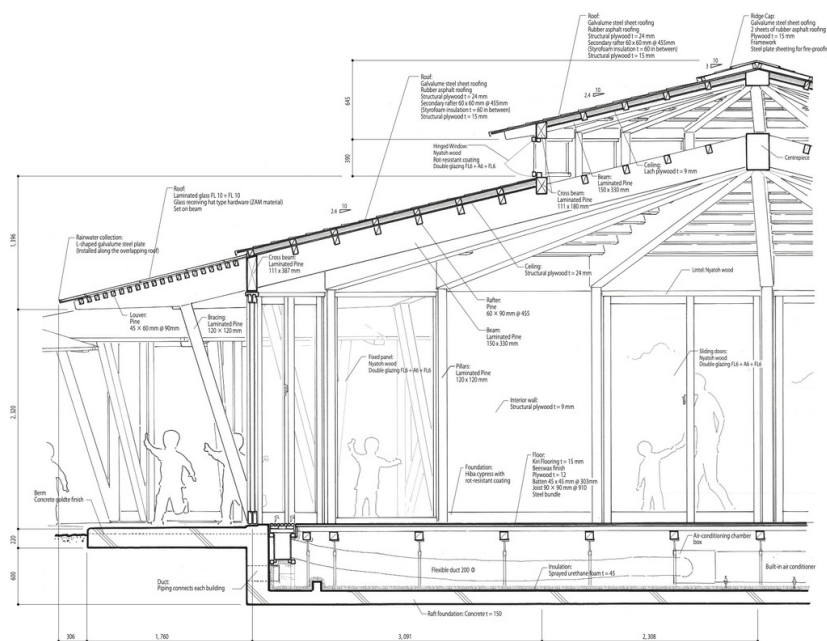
Detalle constructivo del módulo. Esc:1/75
